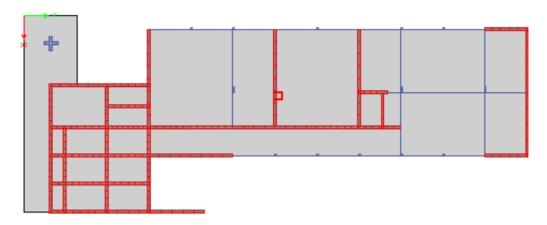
Planta primer piso, Bloque A Municipalidad.
